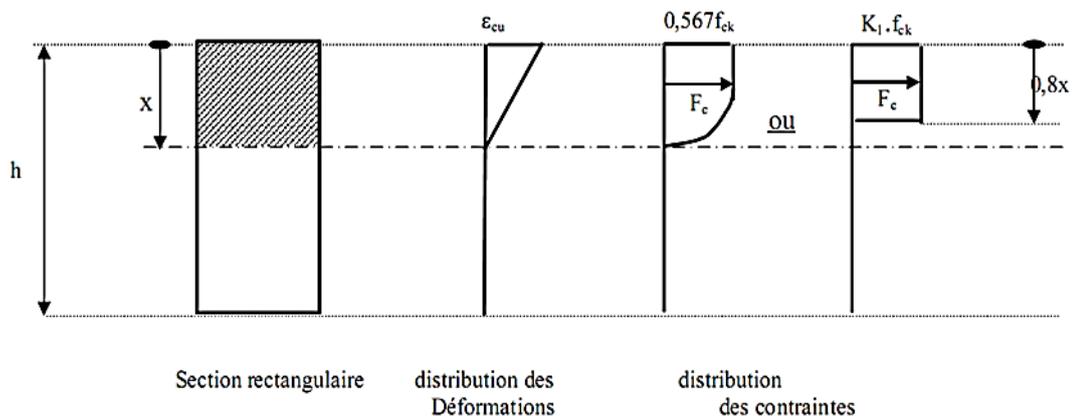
Image instantanée à L'E.L.U. D'une section rectangulaire en béton seul (béton armé-2006)
